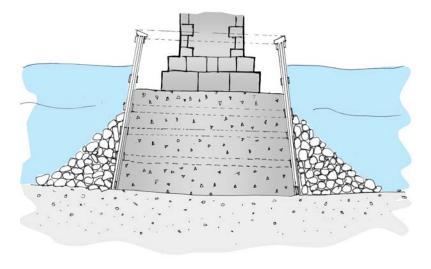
Cimentación directa con hormigón sumergido, cajones sin fondo.
